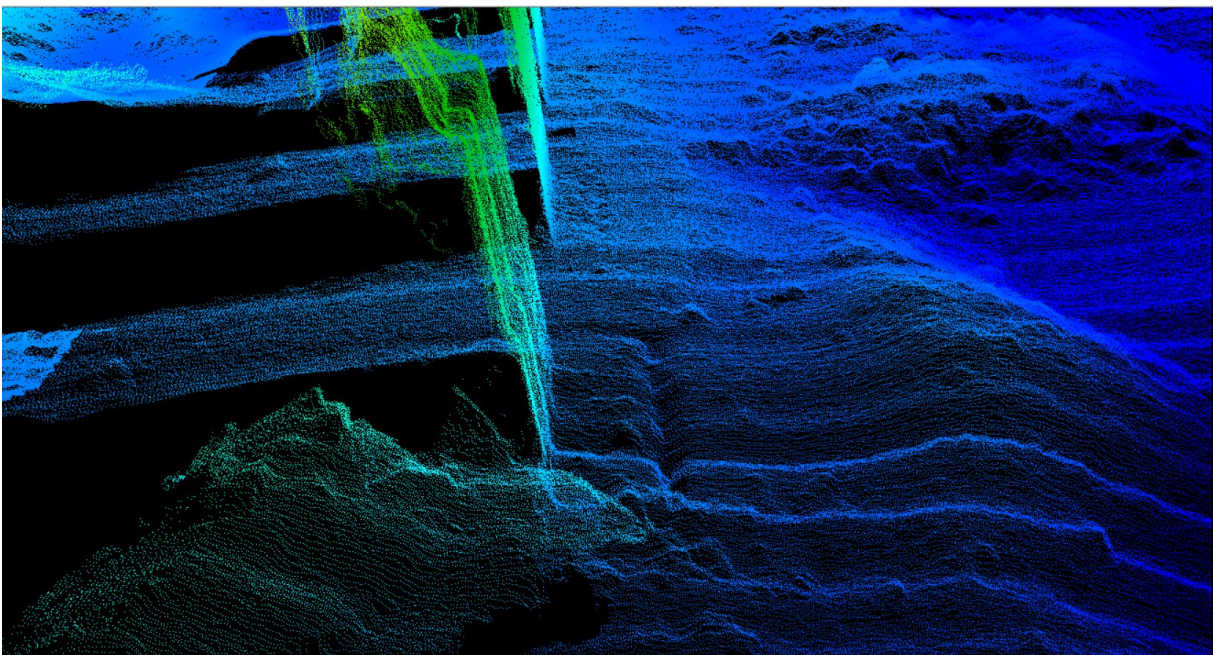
Desplazamiento de bloques y cimentación de pila P5.
